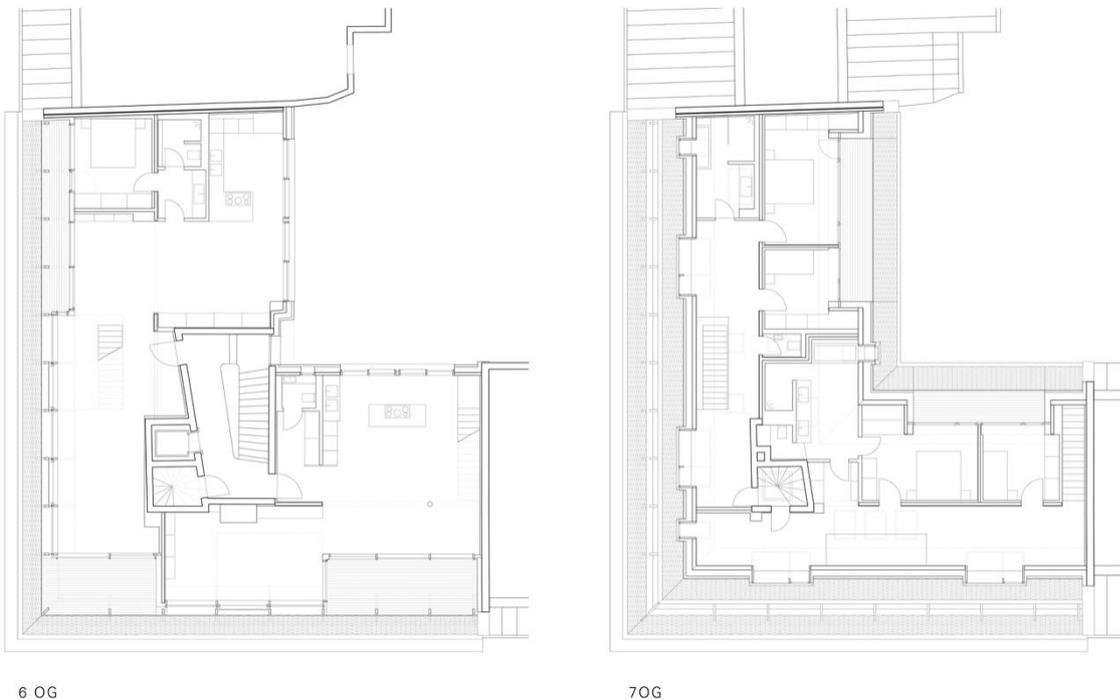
Grundrisse 6. Und 7. OG
